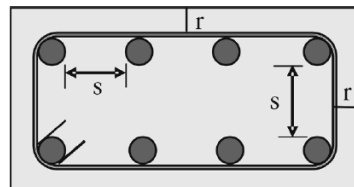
Zonas de Taslapos y Separación del Refuerzo Longitudinal en Columnas DES. Adaptado de: (Rochel Awad, 2012)
